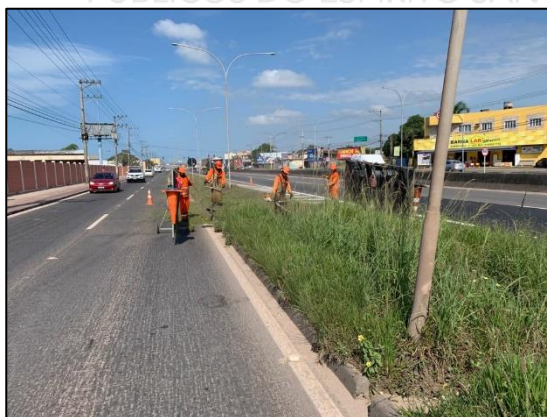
e 08 – Fiscalização dos serviços de Conserva Especial do Pavimento
